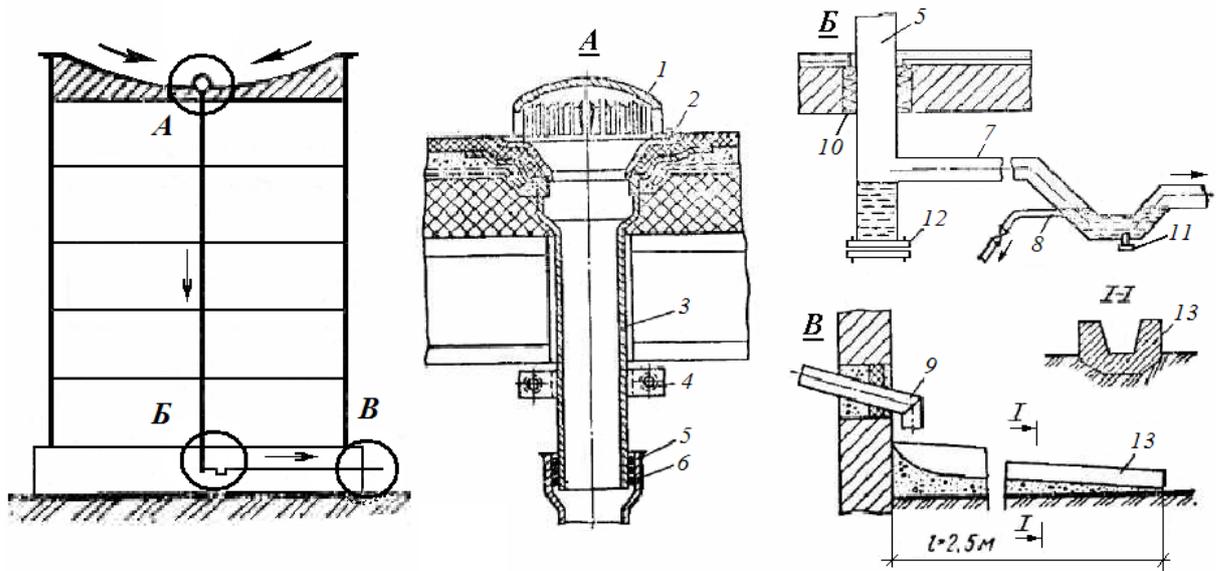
Схема внутреннего водоотвода жилого дома с наружным выпуском и детали узлов (А, Б, В):
